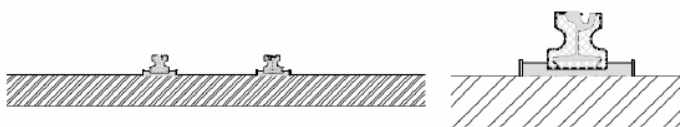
Fase 3. Retirada de los pórticos y encofrados para el hormigonado.
